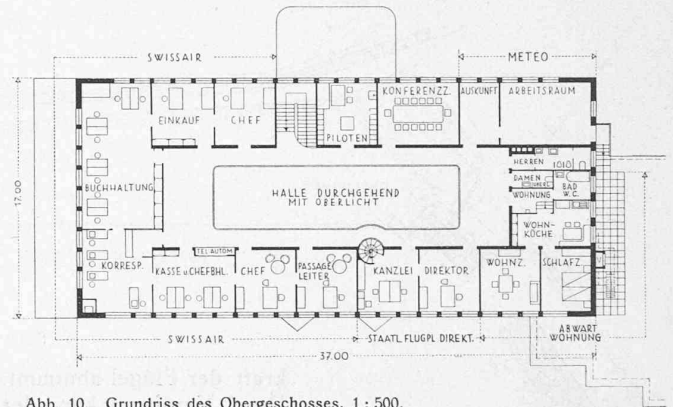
Grundriss des Obergeschosses, 1 : 500.
